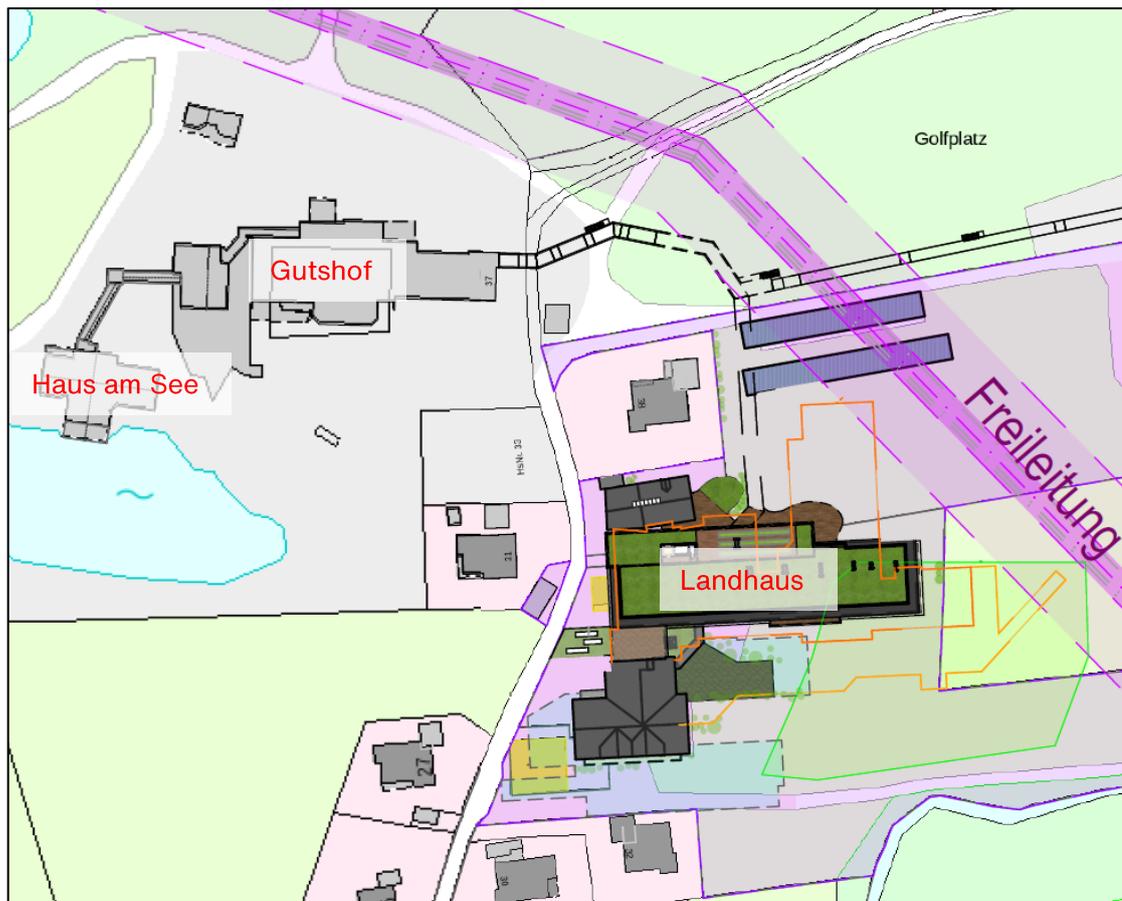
Lageplan Vorhaben [3], ohne Maßstab
